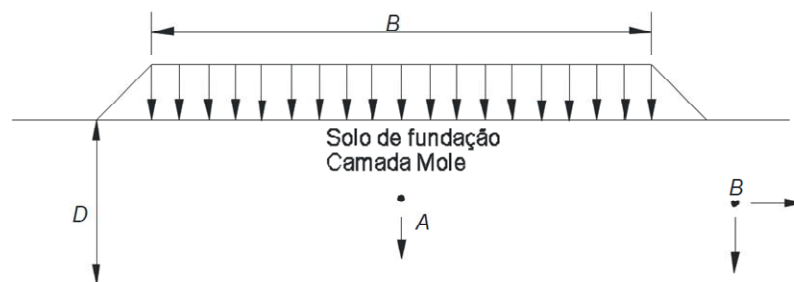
deslocamentos verticais e horizontais sob pontos na borda e no centro de um aterro em construção (ORTIGÃO, 2007, p. 135)
